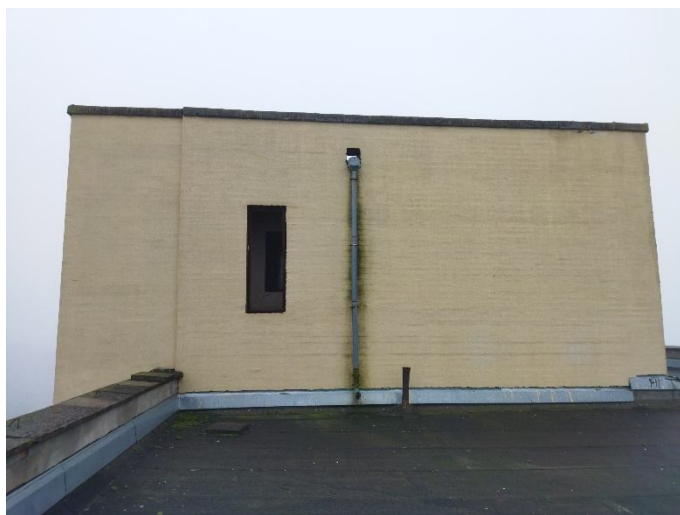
Вид на надстройку на покрытии (2 подъезд)
